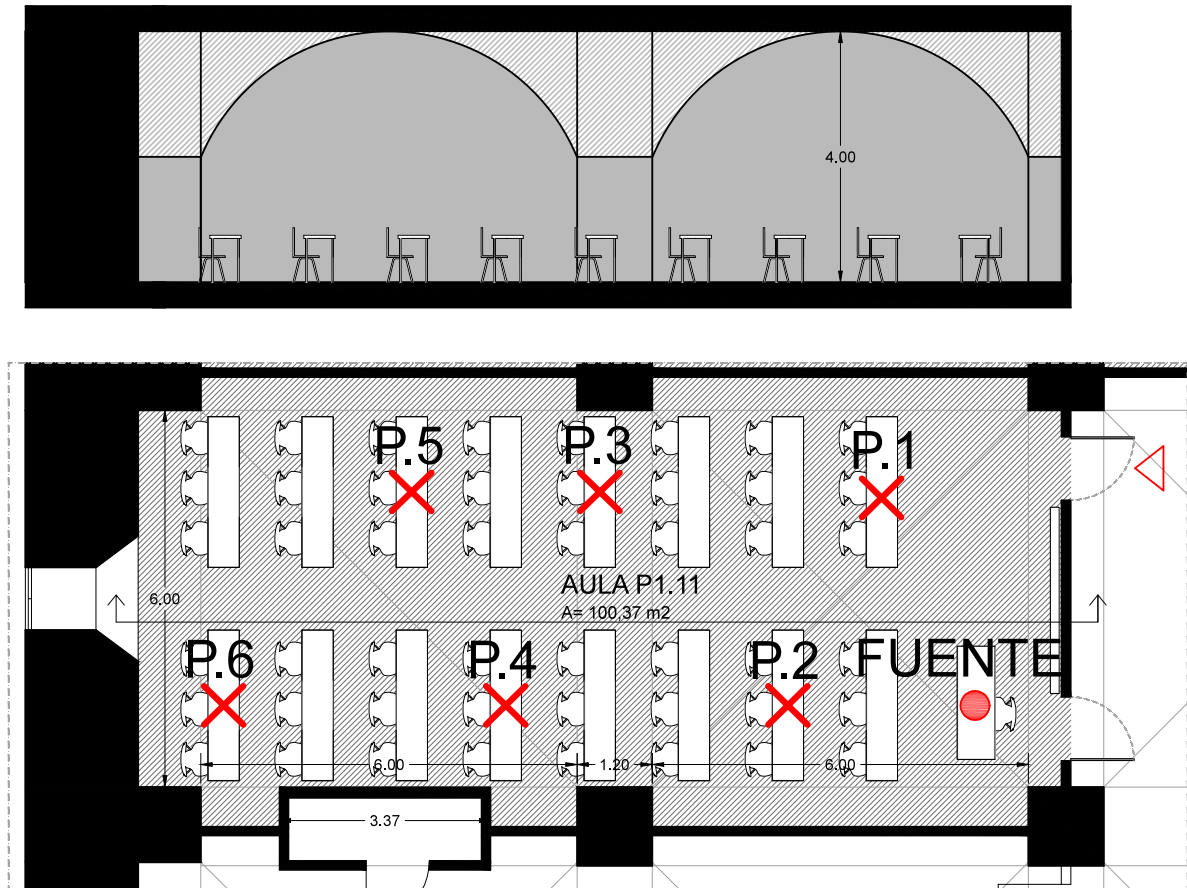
Planta y alzado del aula P1.11 de la ETSIT.
